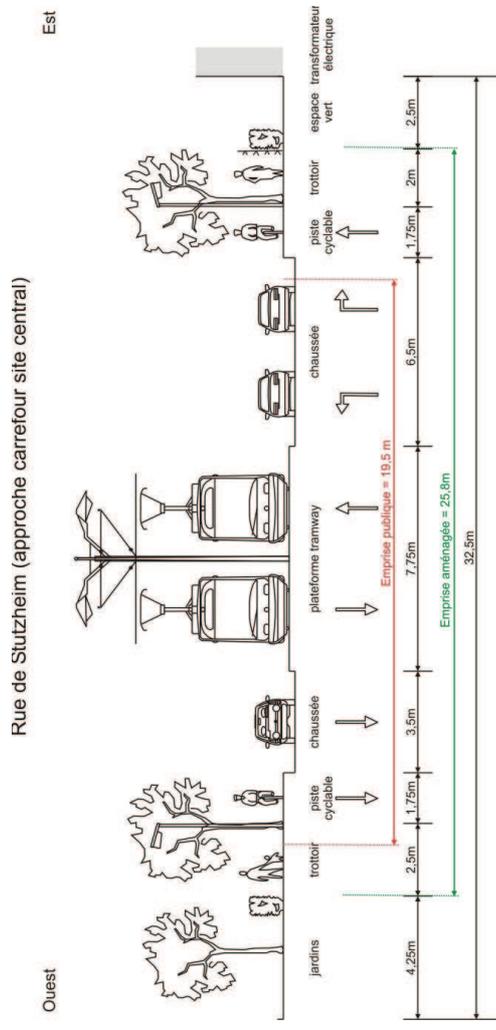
Situation projetée (coupe 6) sur la rue de *Stutzheim* (site central)
